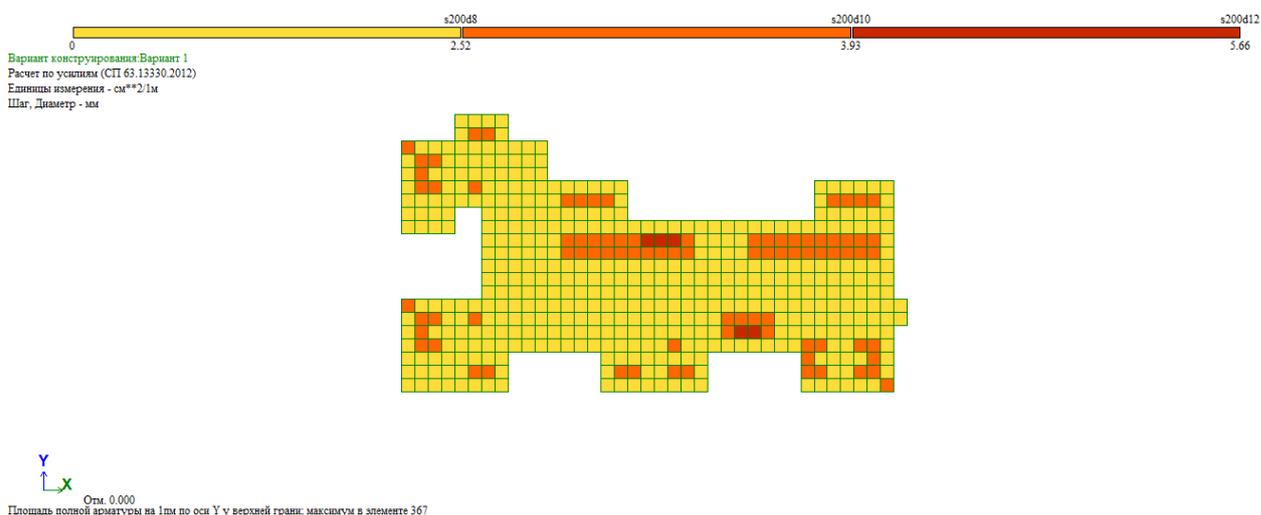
Подбор верхней продольной арматуры плиты по оси Y
